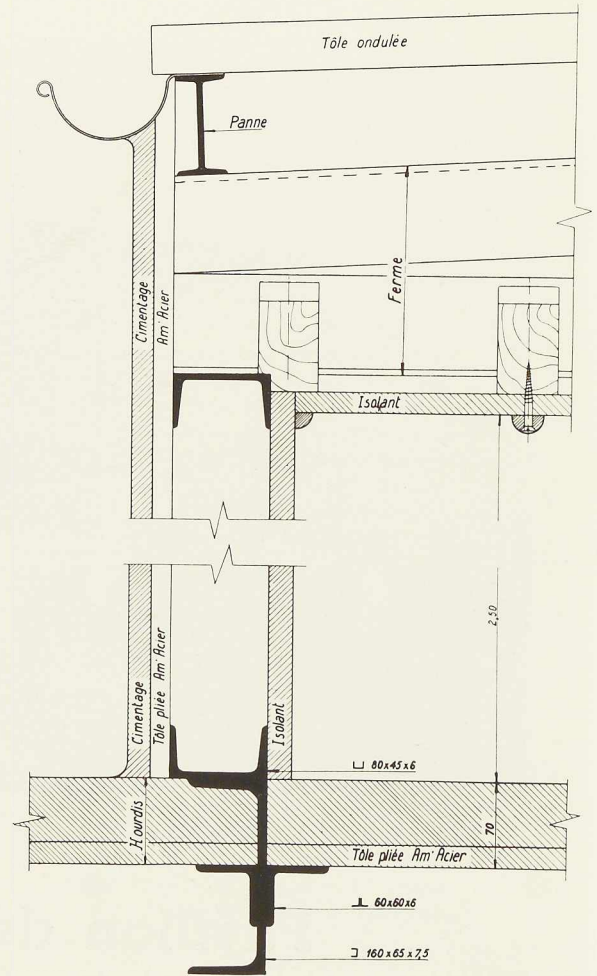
Coupe dans un mur extérieur, montrant la constitution du hourdis, du mur extérieur et de la toiture.
